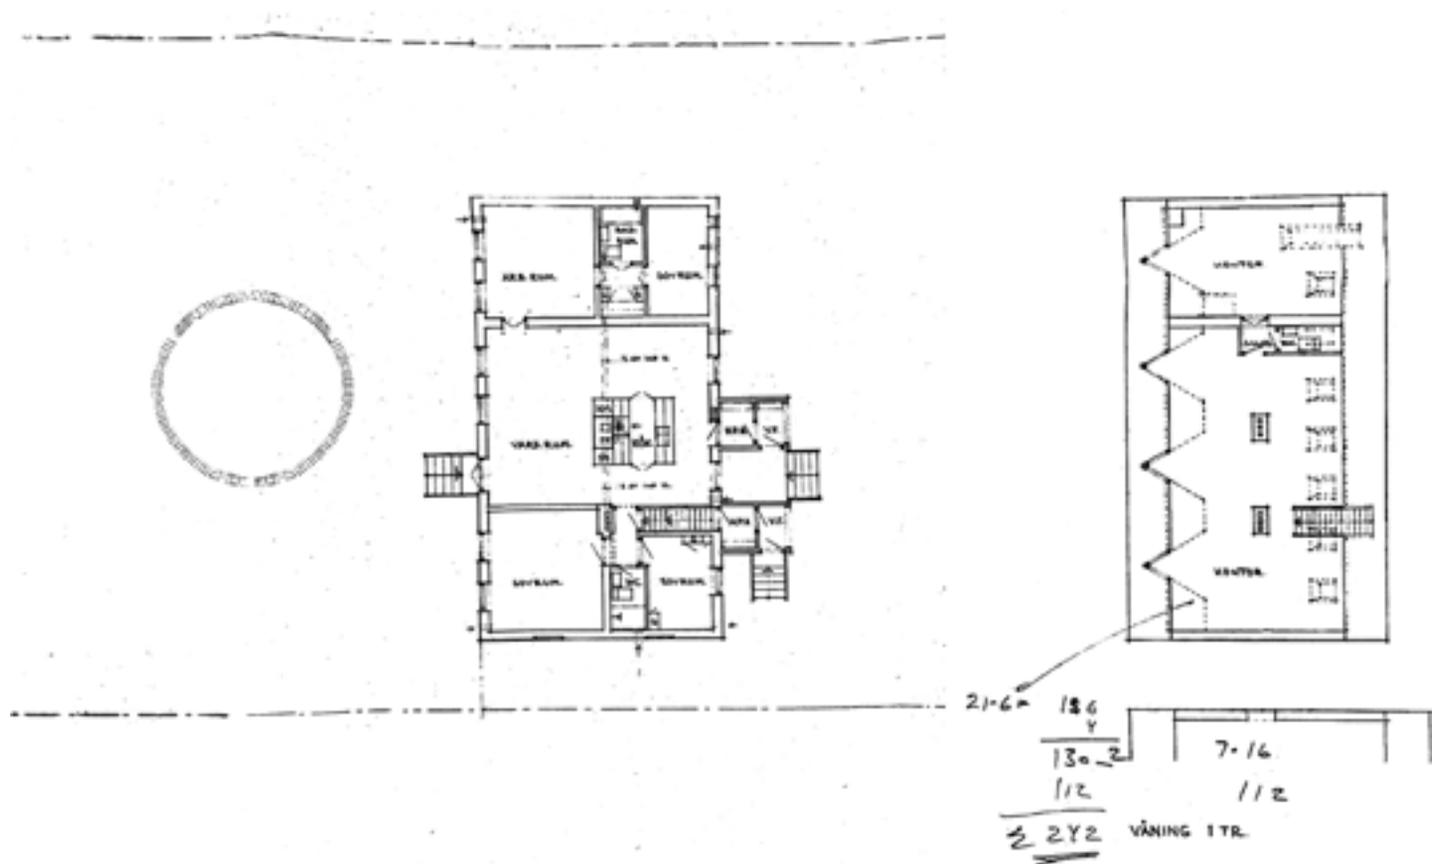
Planos originales de planta baja y planta bajo cubierta. Klas Anshelm, Lund. 1964.
